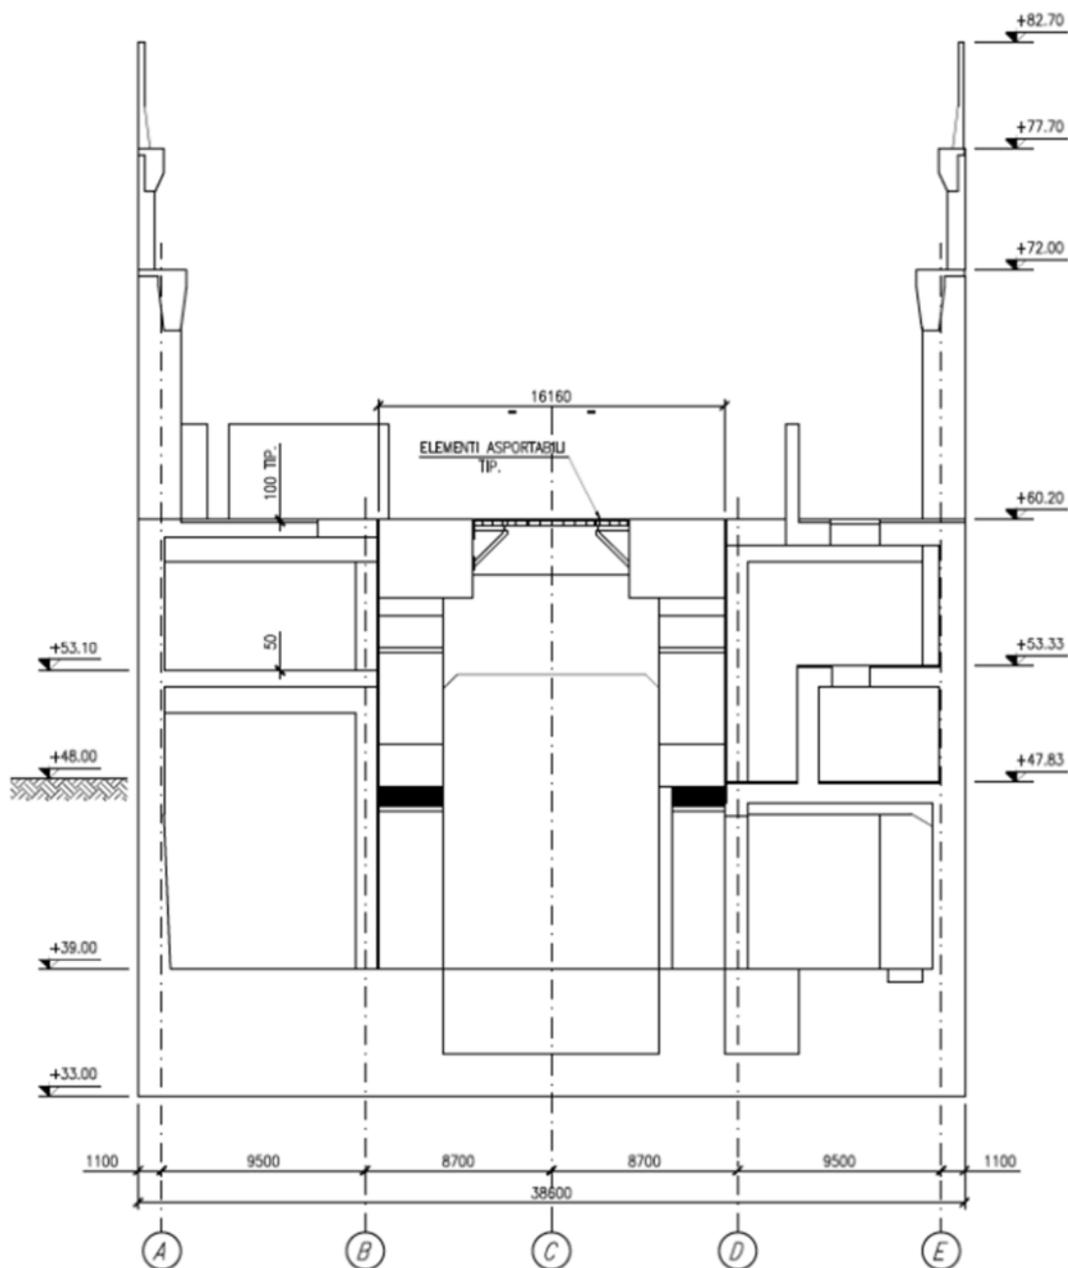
Sezione trasversale Edificio Turbina (parte in c.a.)
